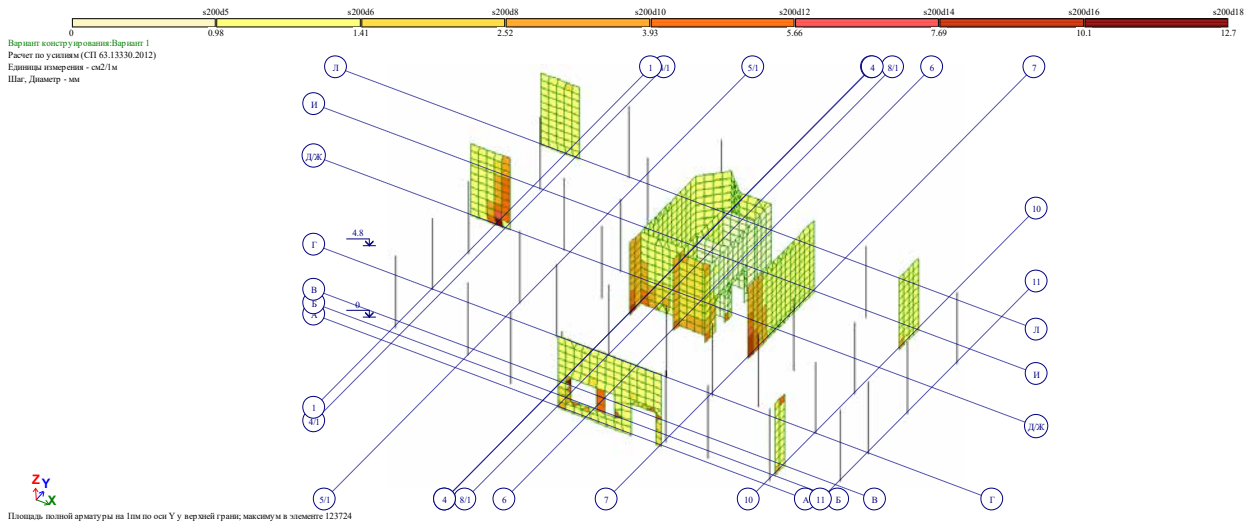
Площа верхньої арматури на 1 м.п.
